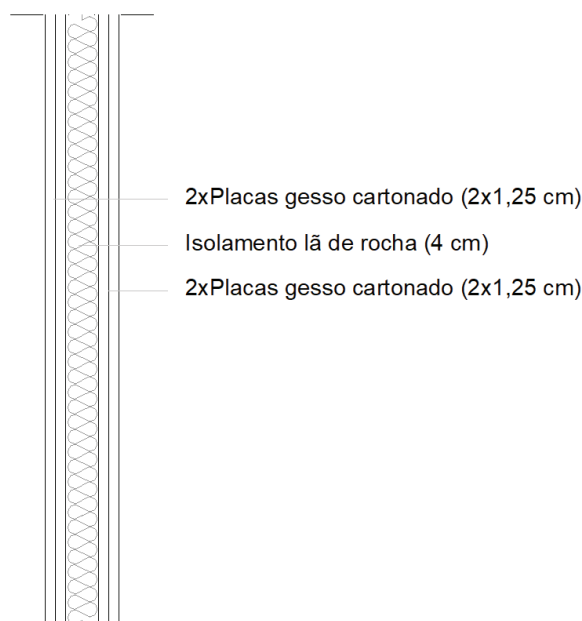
Pormenor construtivo da parede interior tipo VI (circulação)
